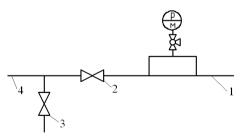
Схема трубопровода от гидравлического пресса к системе отопления: 1 – трубопровод к системе; 2, 3 – вентили; 4 – трубопровод от гидравлического пресса
